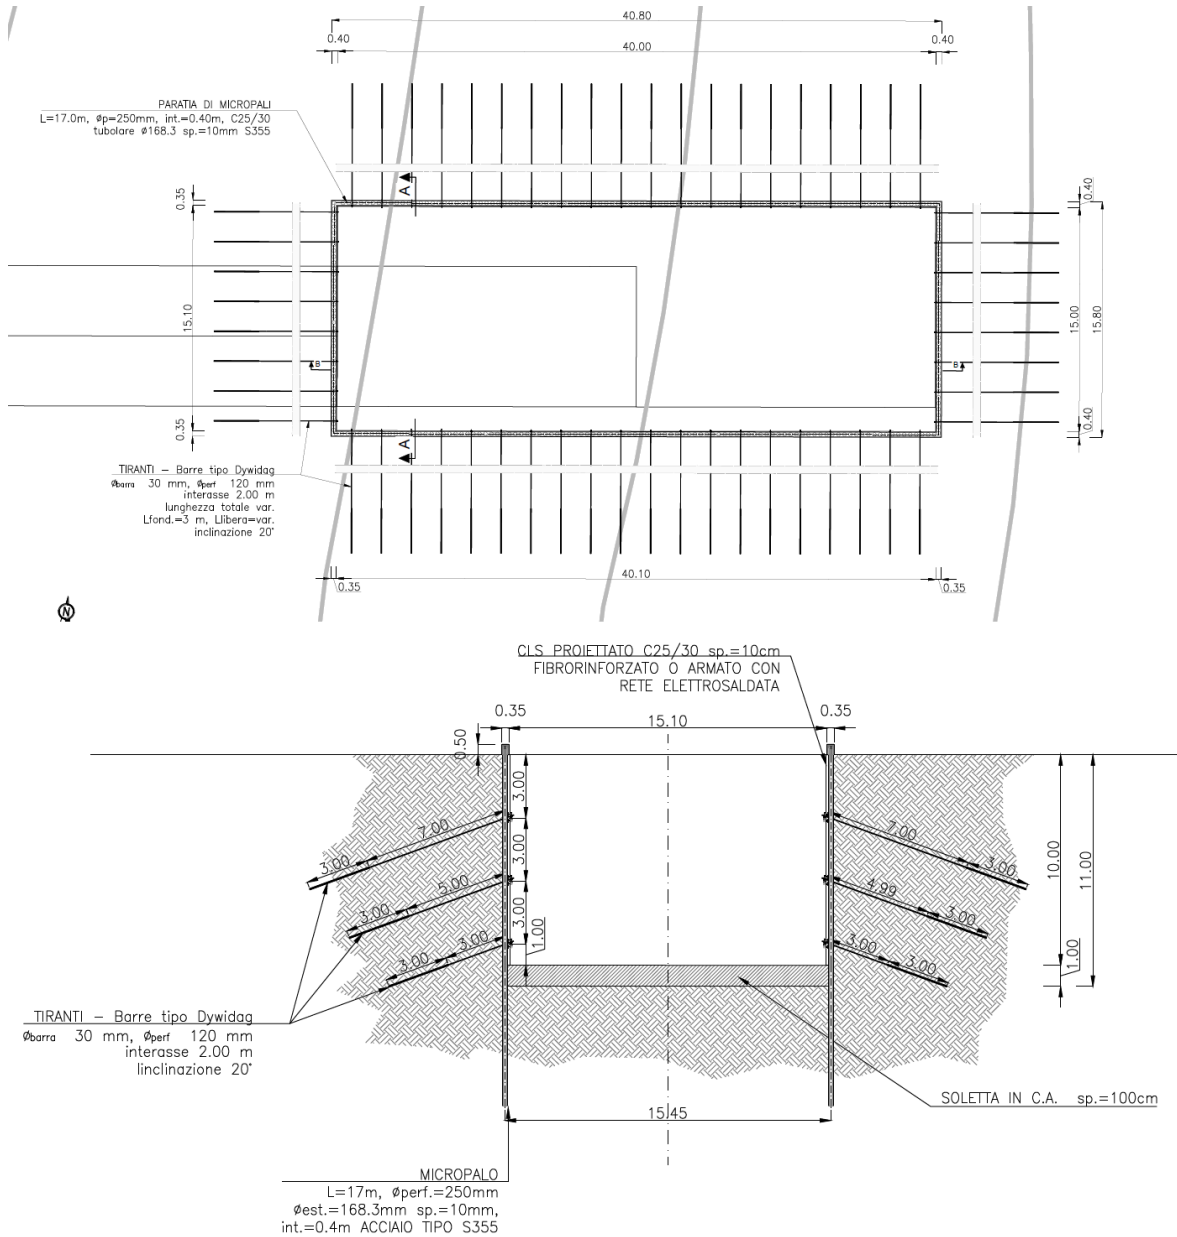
Planimetria e sezione tipo della paratia di imbocco della discenderia
